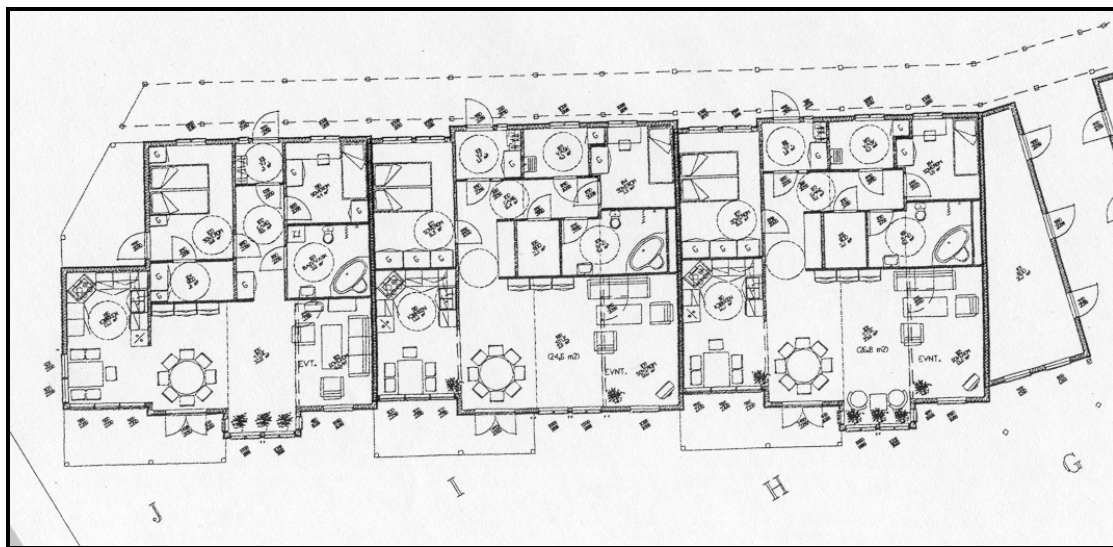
Typvåningsplan Saghausen Terrasse.
